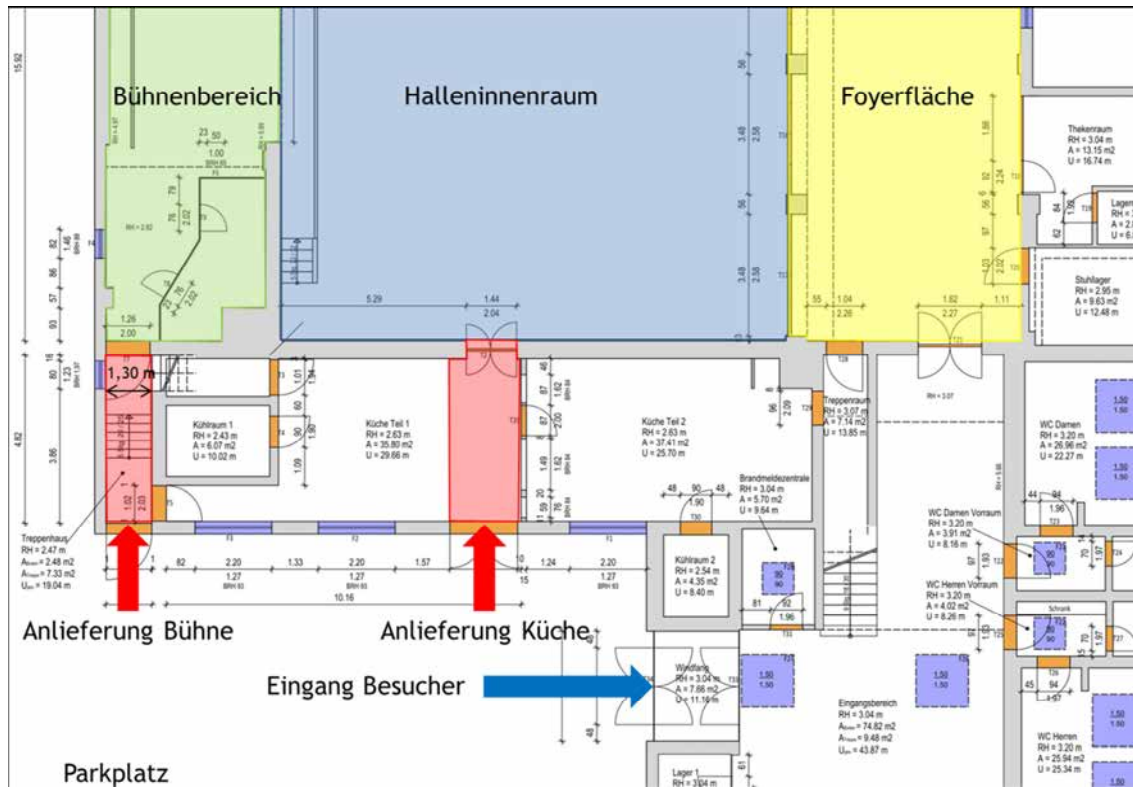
Flächen-, Eingangs- und Anliefersituation im Erdgeschoss
